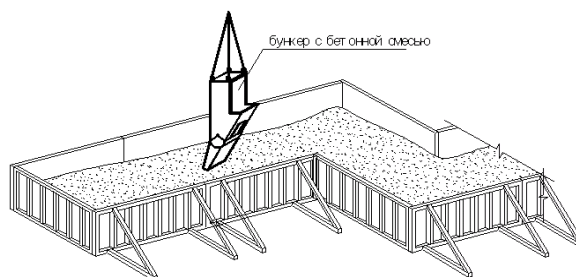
Схема укладки бетонной смеси методом «кран-бадьа».
